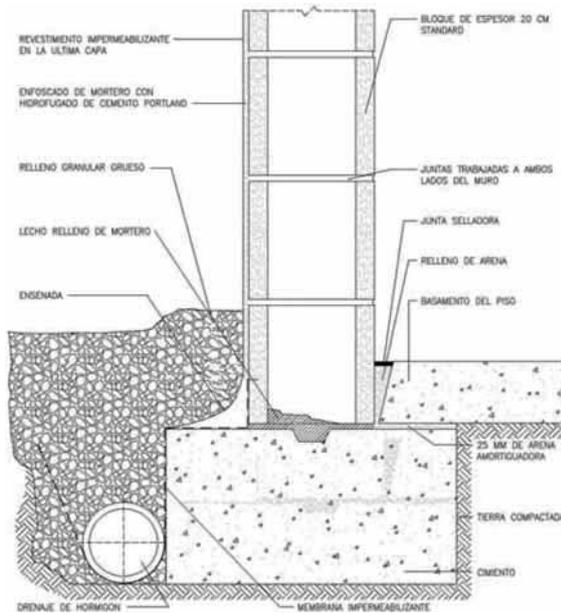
Sección de arranque sobre cimentación de muro de 1 hoja de bloque hueco de carga.
